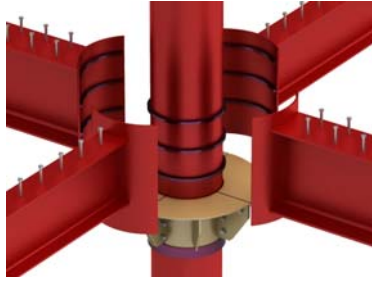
ES-TD Grout-Jacket의 체결 전 내부모습
